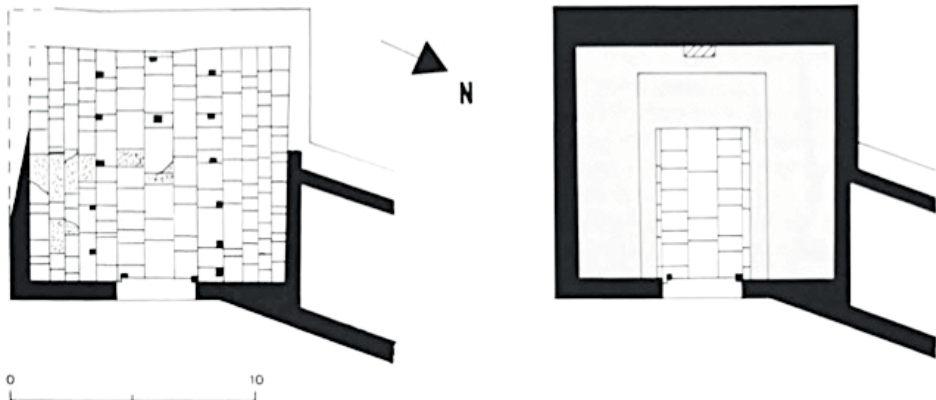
Plano en detalle y propuesta reconstructiva de la sala H de Dougga.
